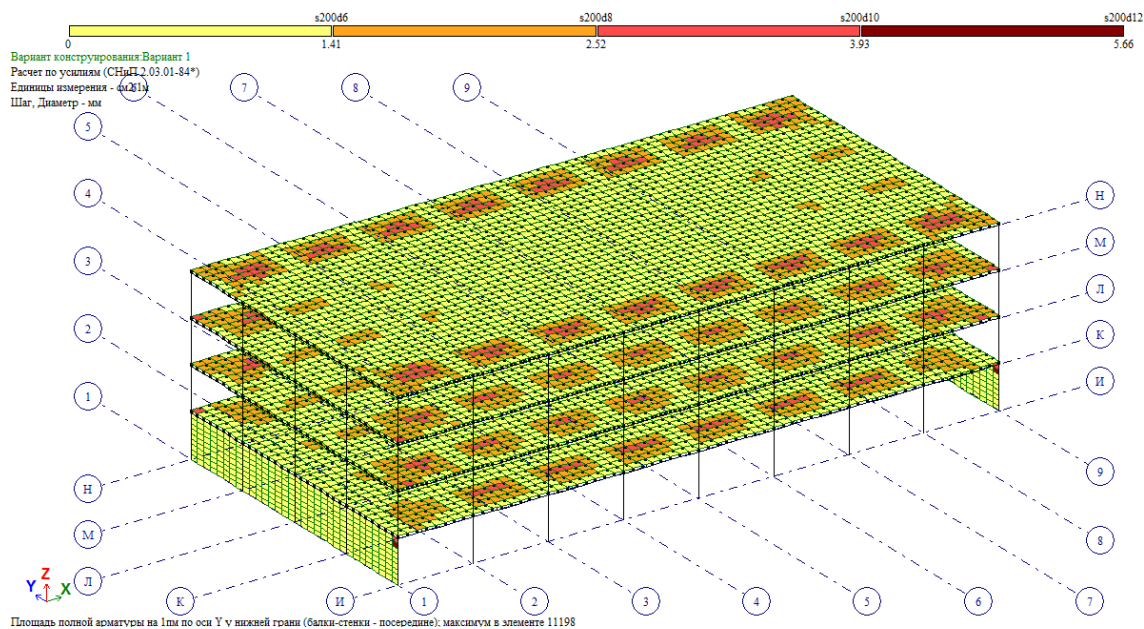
Нижнее армирование плит по оси OY. Армирование стенок нулевого этажа
